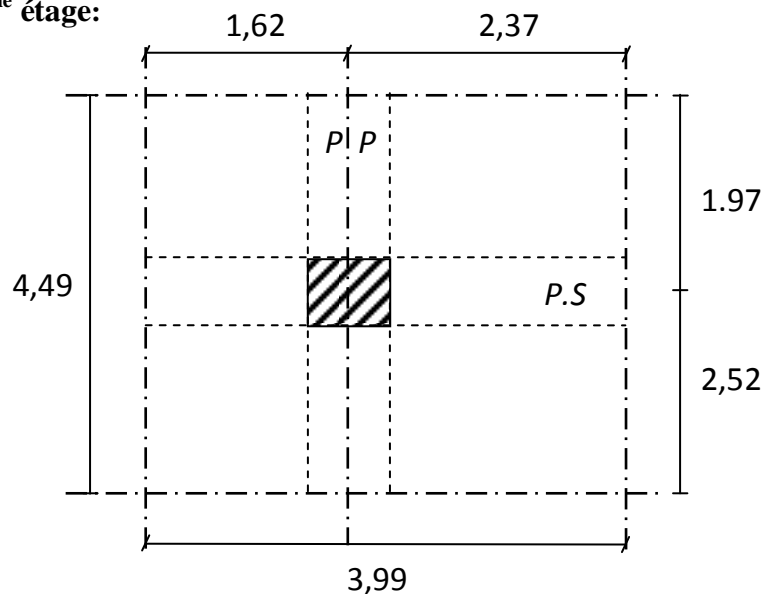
Section afférente d'un poteau centrale sollicité.
